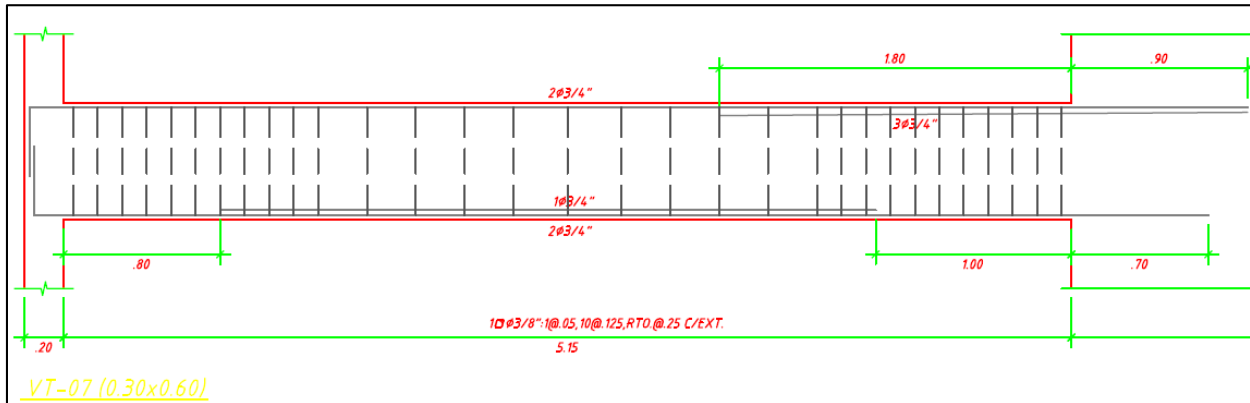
Elevación de viga VT-07. Primer tramo.
